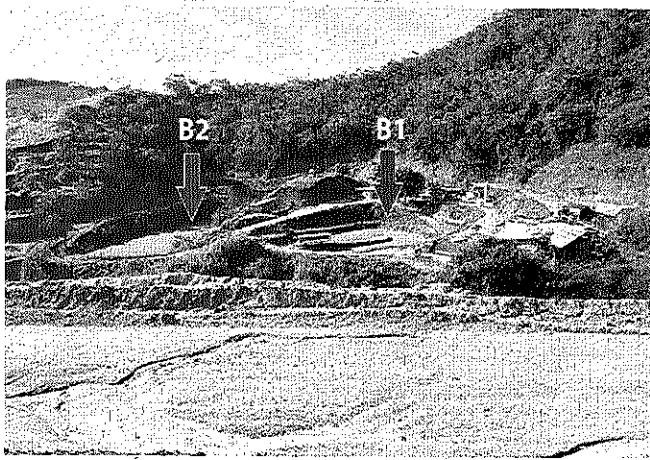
Vista geral das bacias de decantação de rejeitos industriais.
